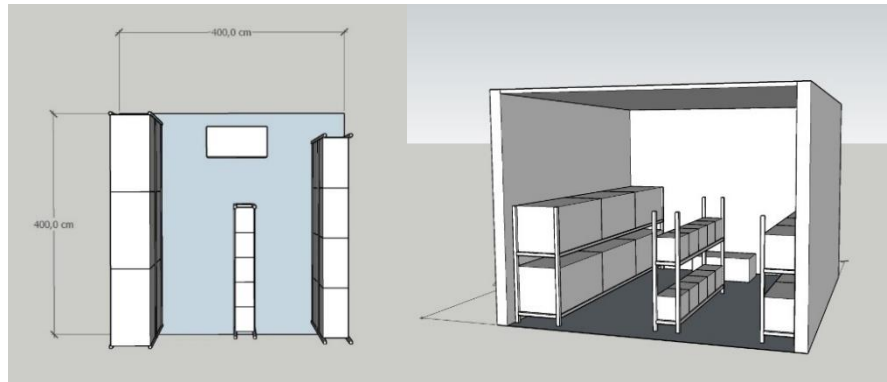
14 Layout Ruang Kios Burung Tipe C
